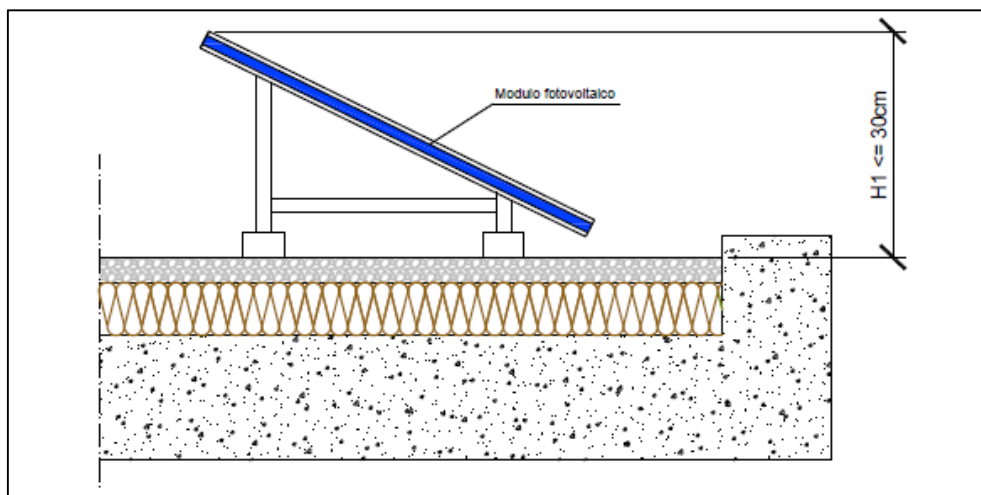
Figura II: Schema esemplificativo installazione idonea su tetto piano in assenza di balastra
